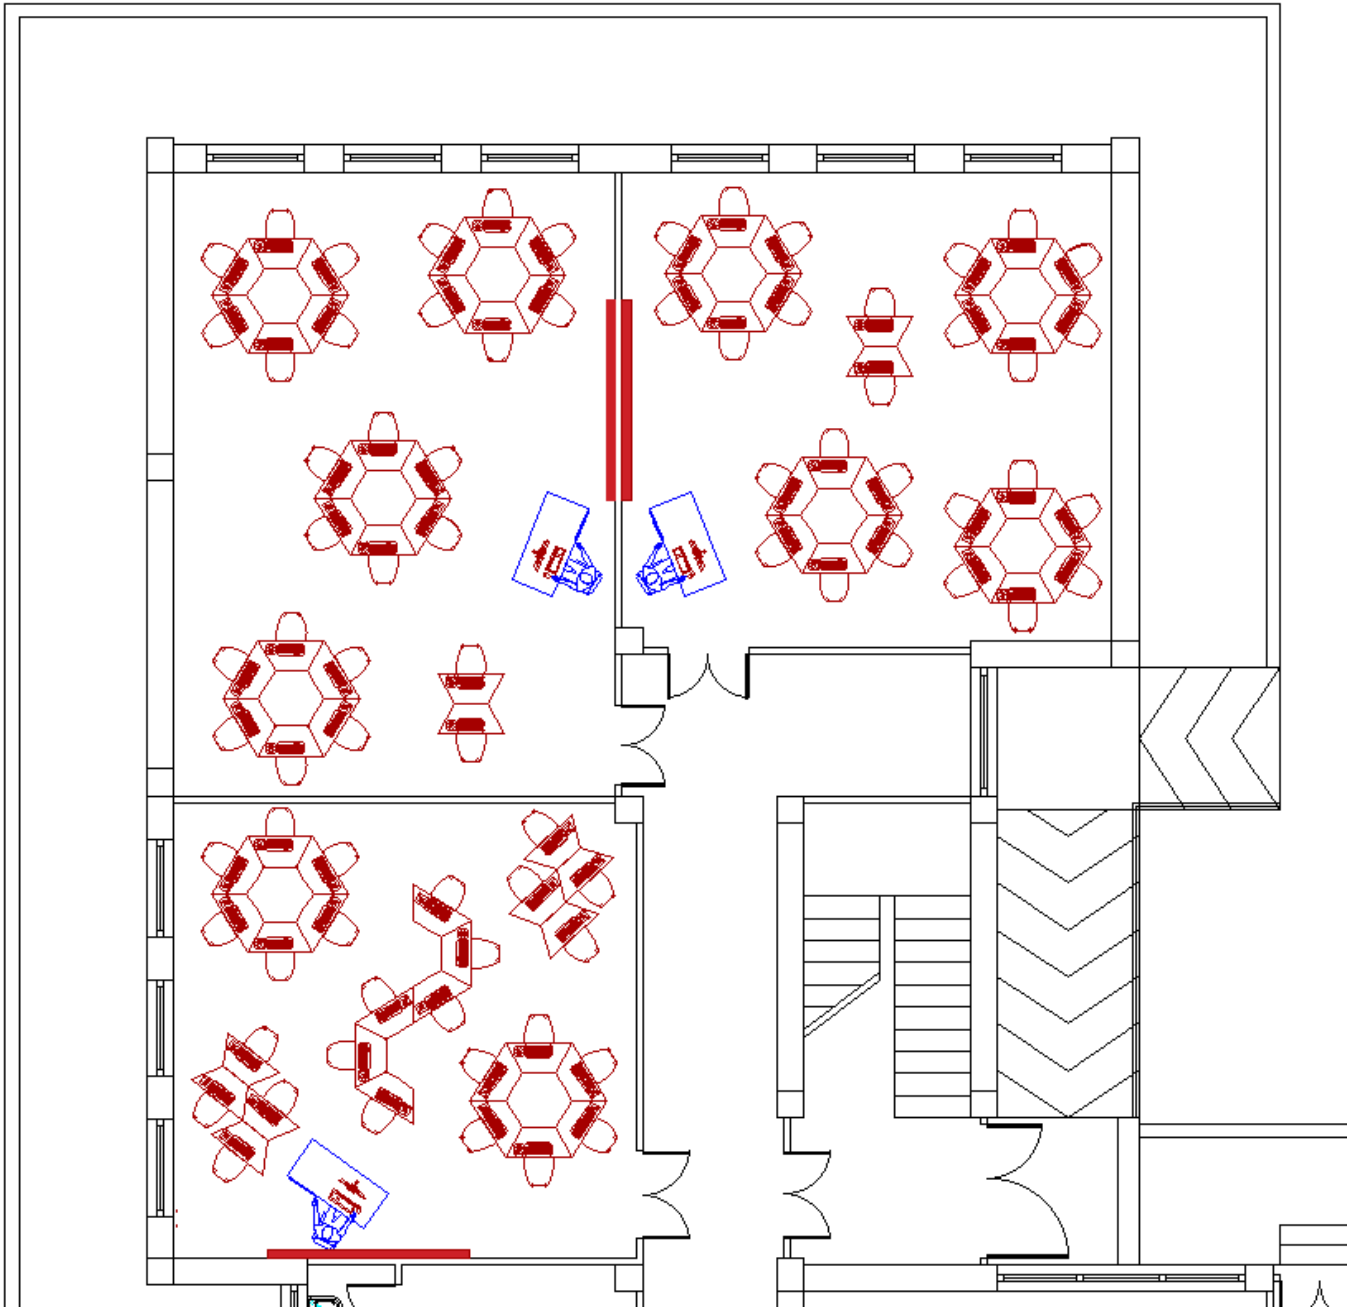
Pianta aule innovative piano rialzato_ plesso di via Pigno
